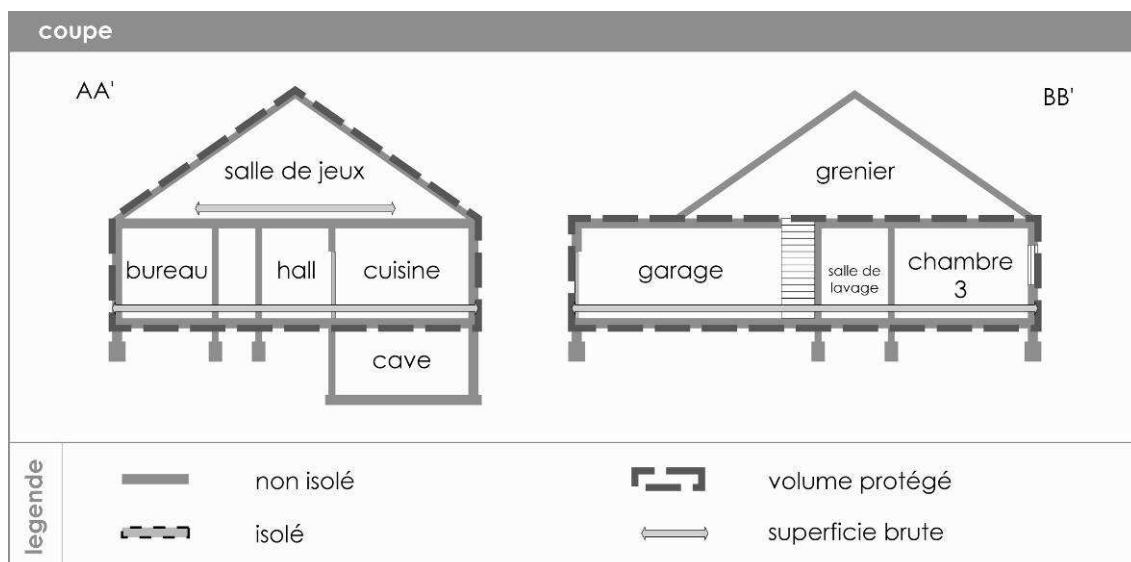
Vue en coupe d'une villa 4 façades avec salle de jeux au grenier
